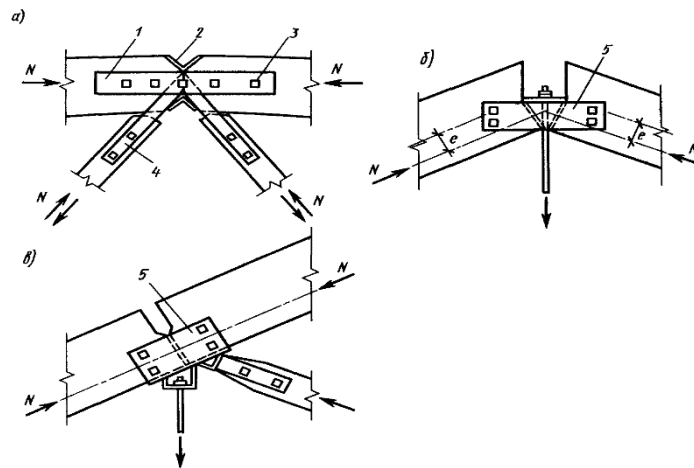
Вузли верхніх поясів клеєнодерев'яних ферм: *а* - сегментний; *б* - трикутної форми коньковий; *в* - те ж, проміжний; 1 - дерев'яна накладка; 2 - сталеві діафрагма; 3 - болт; 4 - сталеві накладки; 5 - сталеві кріплення
